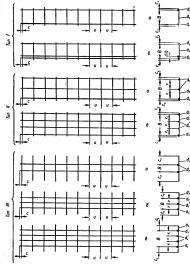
Типы плоских безраскосных арматурных каркасов, изготовляемых на автоматических машинах
